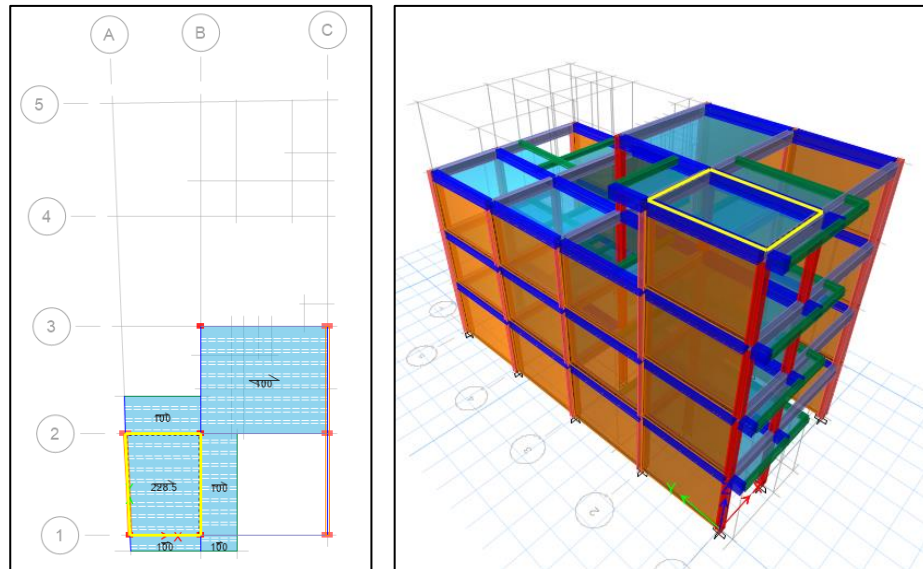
Vista en Planta (Izquierda) y Vista 3D (Derecha) del Área donde será Asignada las Cargas debido al Tanque Elevado en la Vivienda Informal HU-4.
